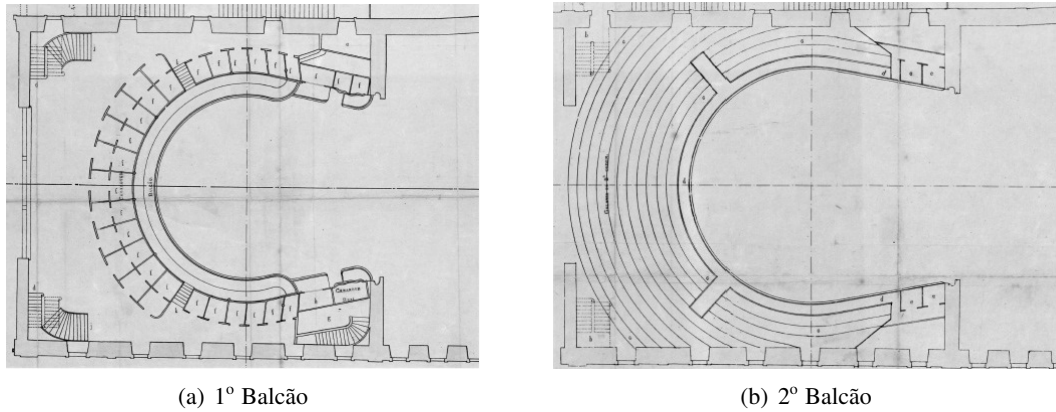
Plantas dos Balcões do Teatro São Luiz (Projecto Original)
